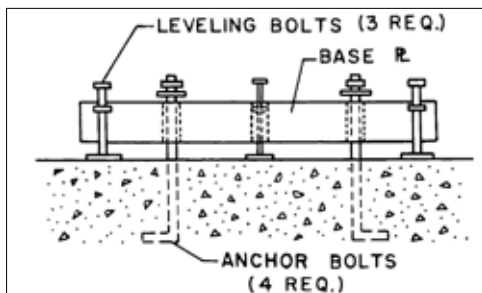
Anclaje de la placa soldada en la base del apoyo<sup>47</sup>
